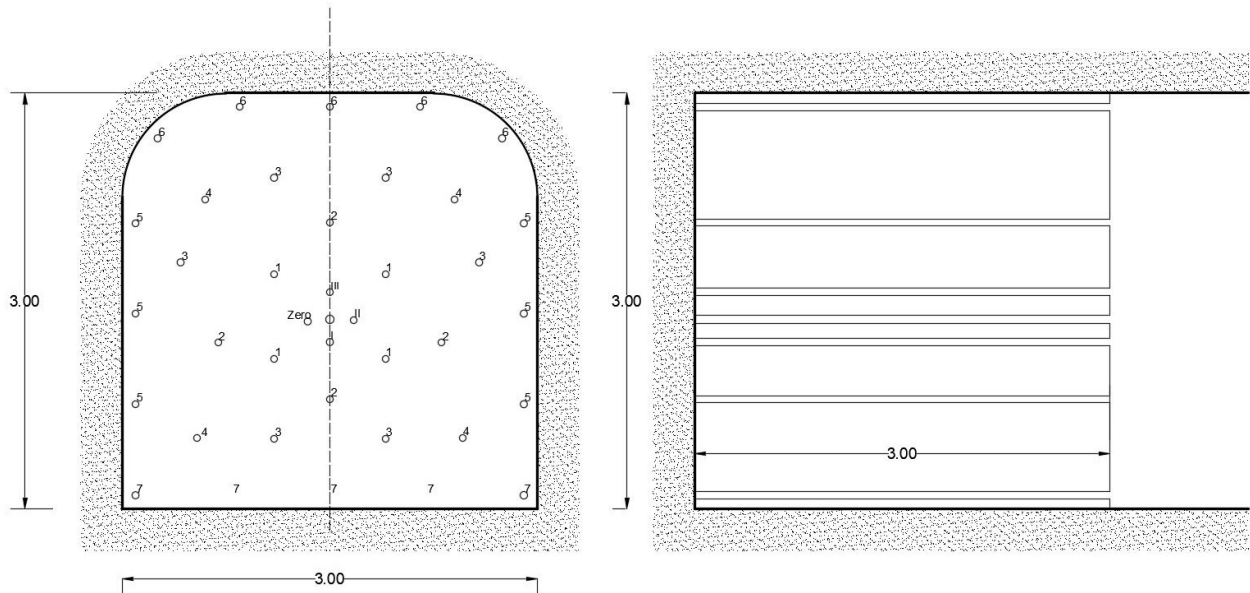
Schema delle volate previste nel metodo "Camere & Pilastrì"
